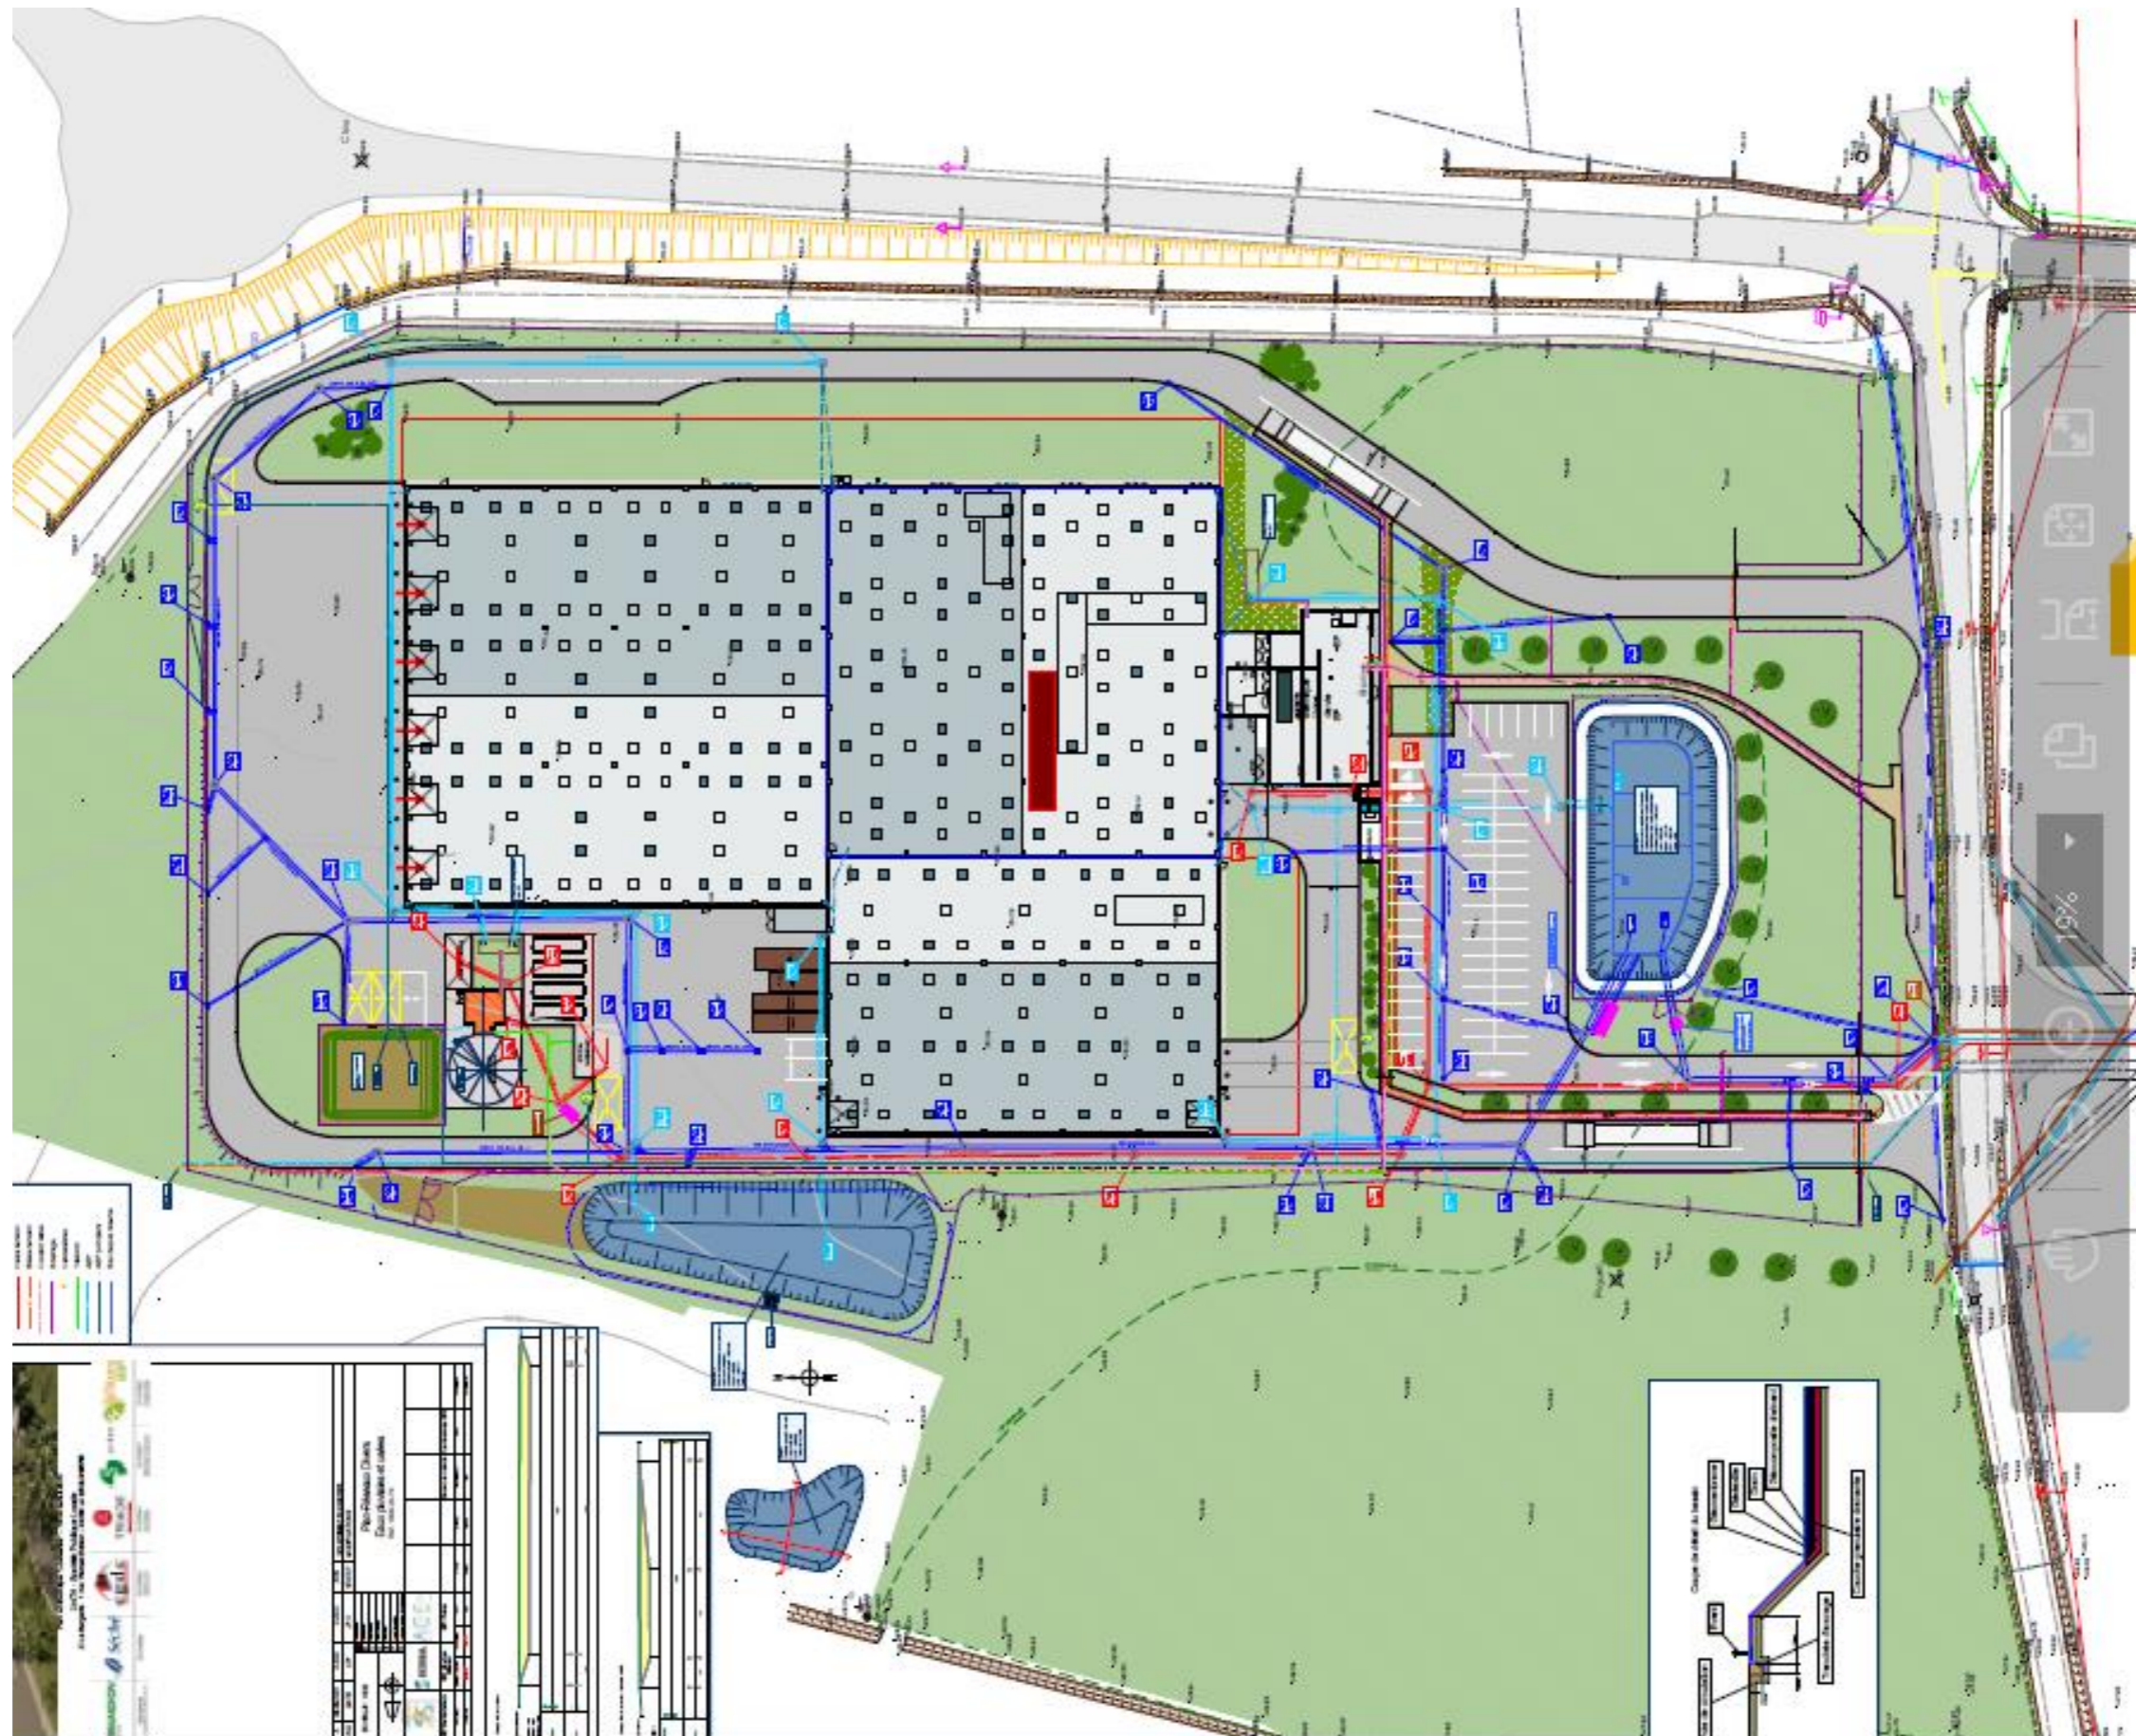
Plan des réseaux (source : groupement Trinovia)
